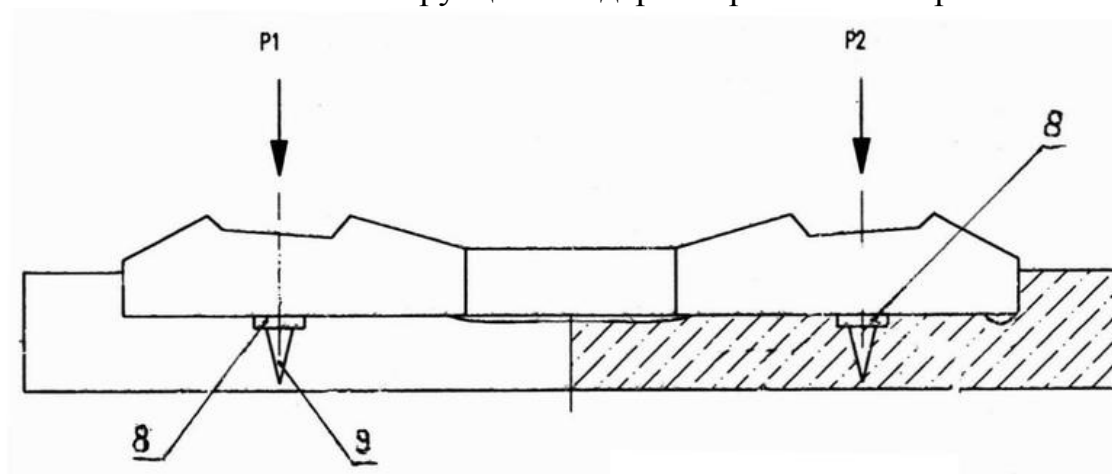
Конструкція рейкової опори із зубатими виступами
